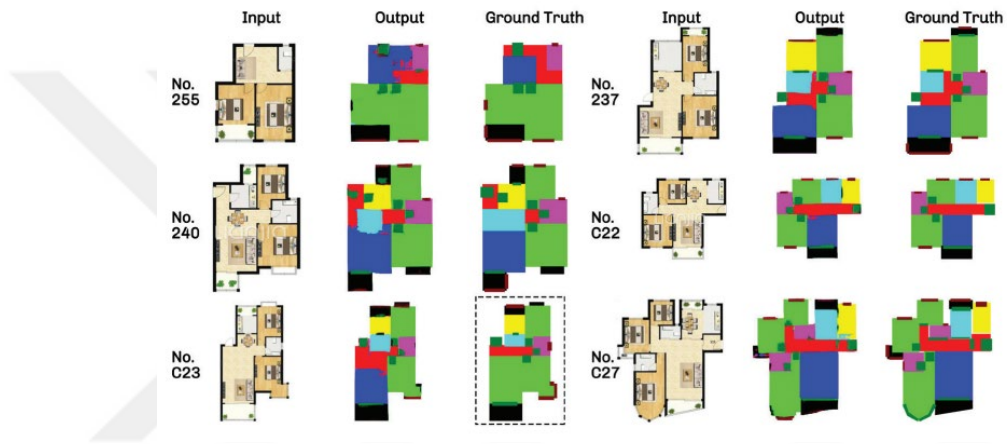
Mimari Çizimleri Tanıma ve Oluşturma Aracında Kat Planı, Etiketlenmiş Plan ve Etiketler (Huang & Zheng, 2018)
